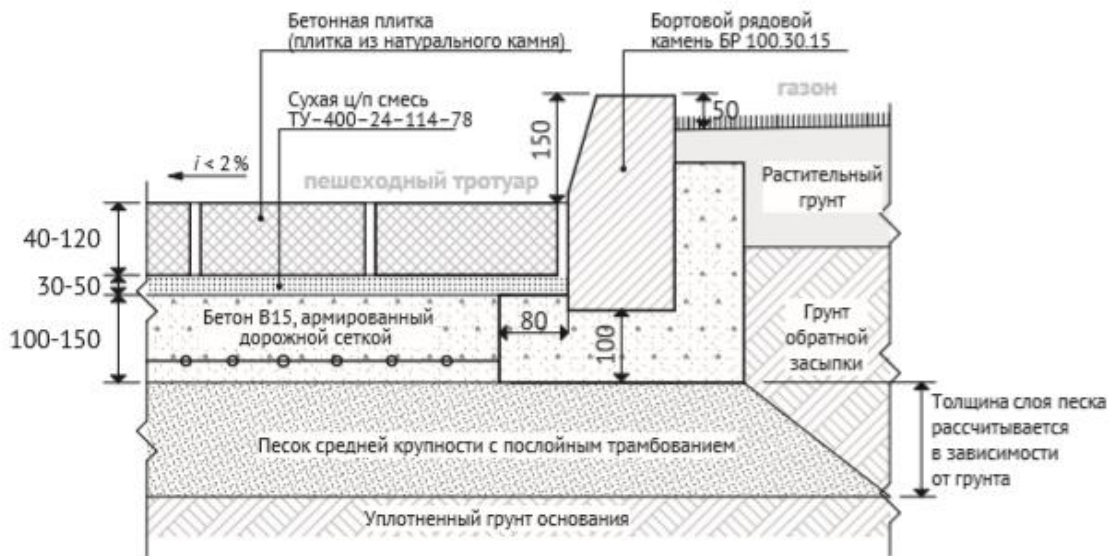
Принципиальная схема устройства сопряжения покрытия из бетонной плитки и газона
